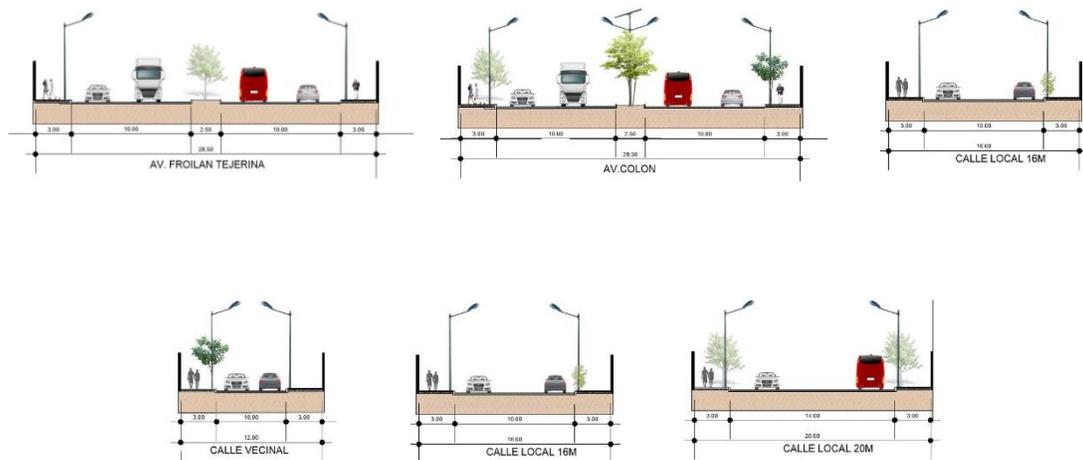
Plano de Estructura vial y transporte – Fuente: Elaboración Propia
